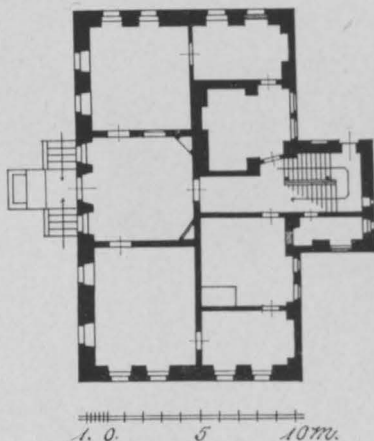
Schenkendorf. Grundriß des Gutshauses.
